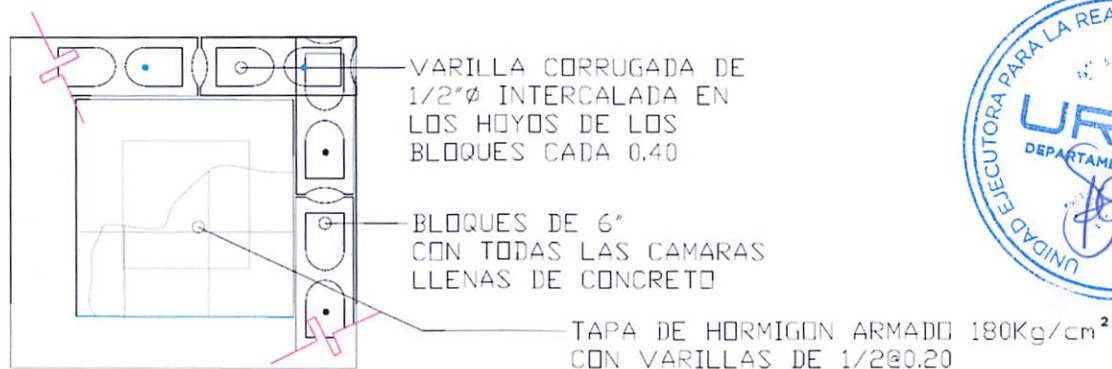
Detalles de registro baja tensión 0.60x0.60x0.60m.
